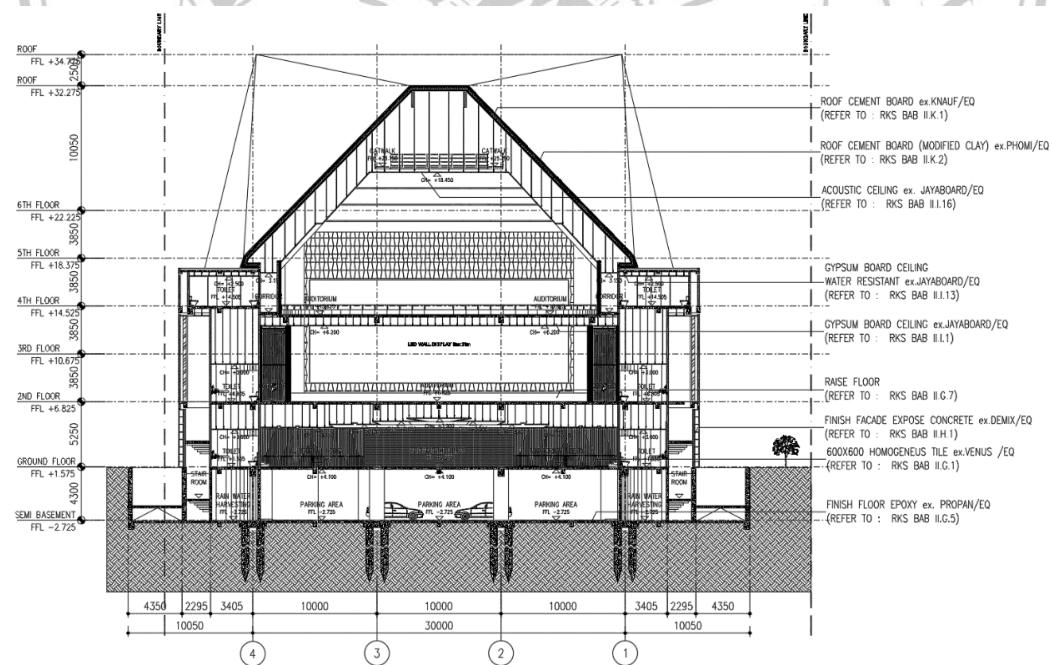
Potongan Bangunan (dari gambar DED *elevation section 1*)
